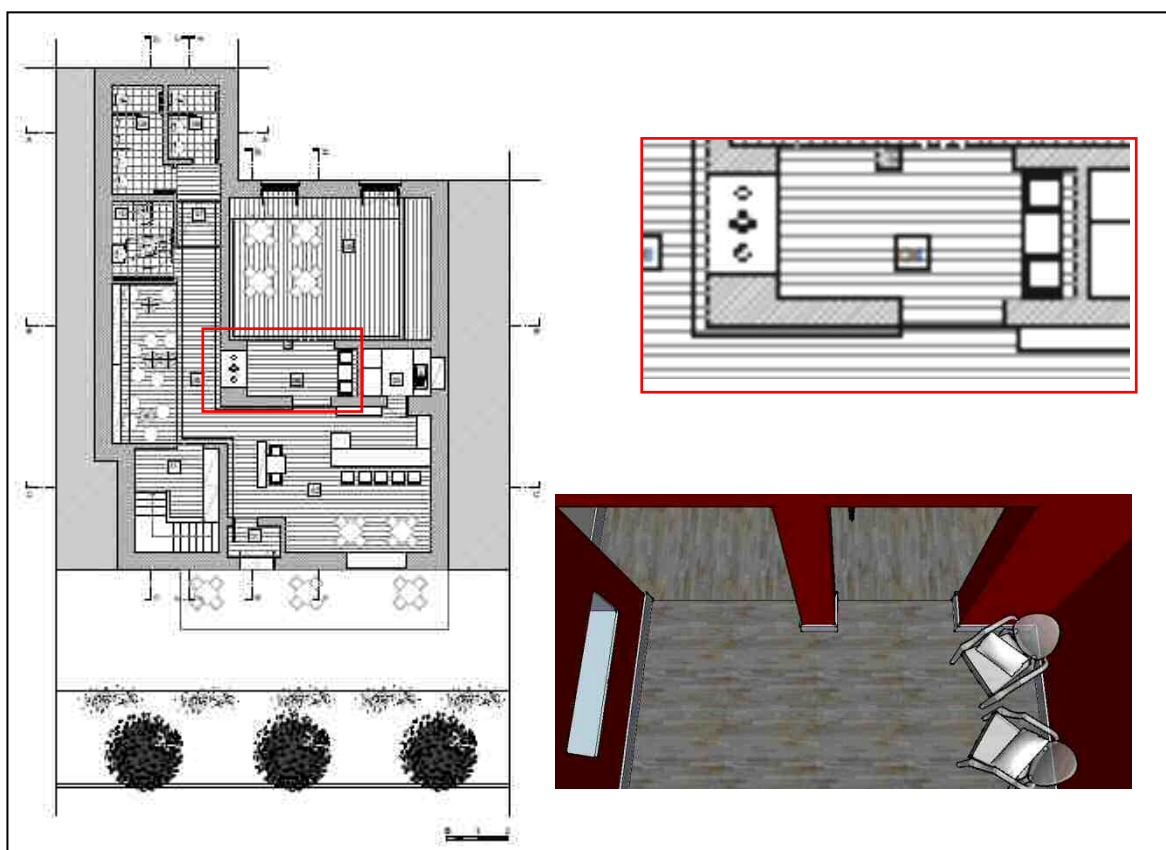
Planta Piso 0, Sala Warm Up, proposta ECB.
